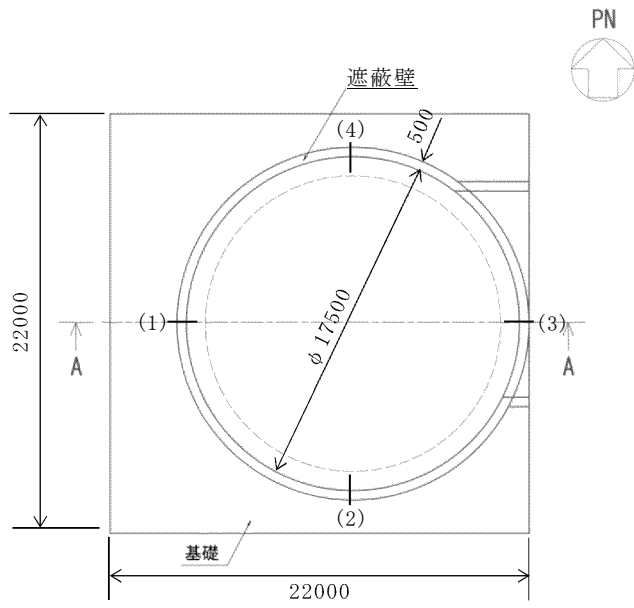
復水貯蔵タンク遮蔽壁 平面図 (単位:mm)
